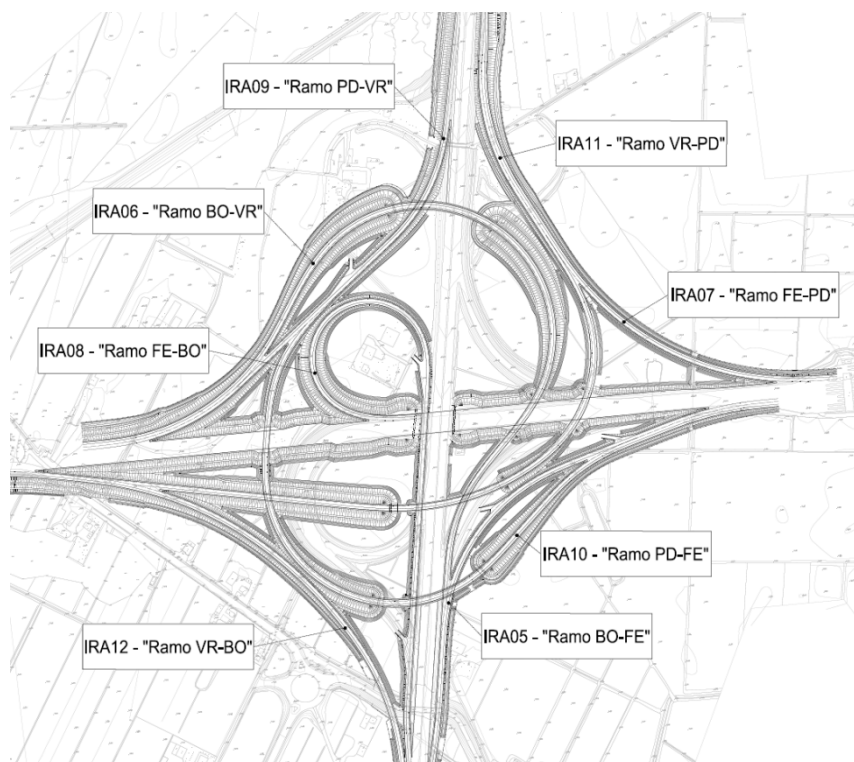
SCHEMA PLANIMETRICO SVINCOLO INTERCONNESSIONE CON L'AUTOSTRADA A13
